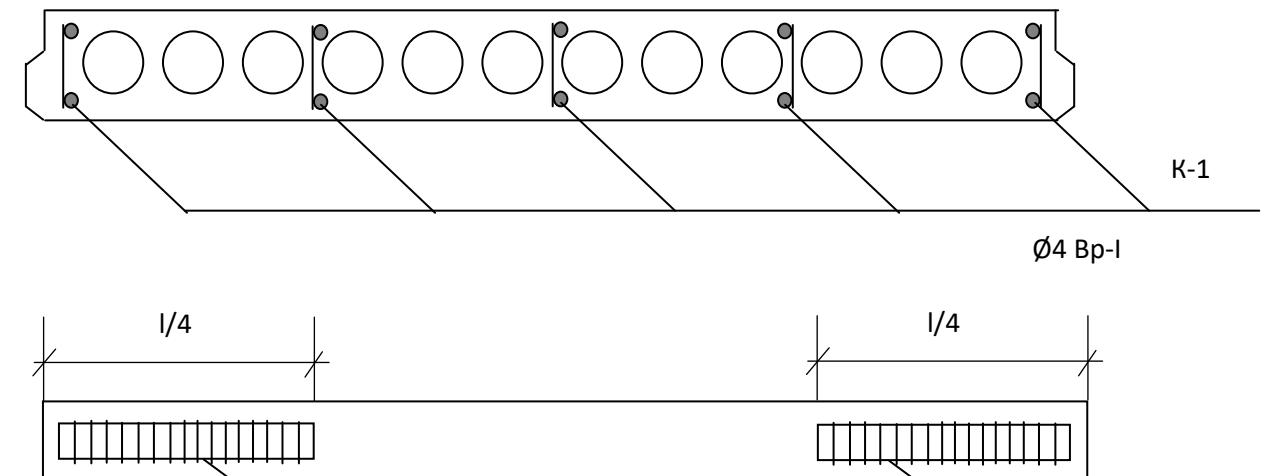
Разм. К-1 – поперечной конструктивной арматуры в поперечном и продольном сечениях плиты (К-1 – сварные каркасы)
